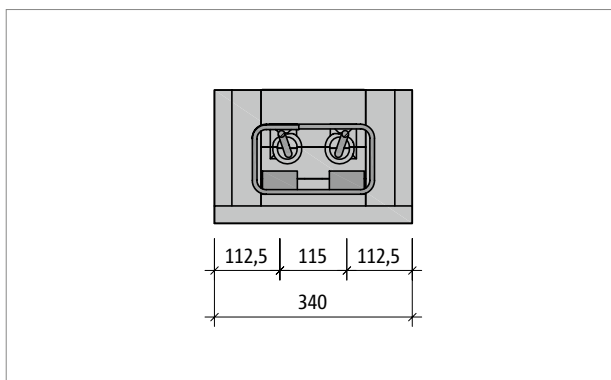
Schöck Isokorb® RT type SQ-V3: Doorsnede
